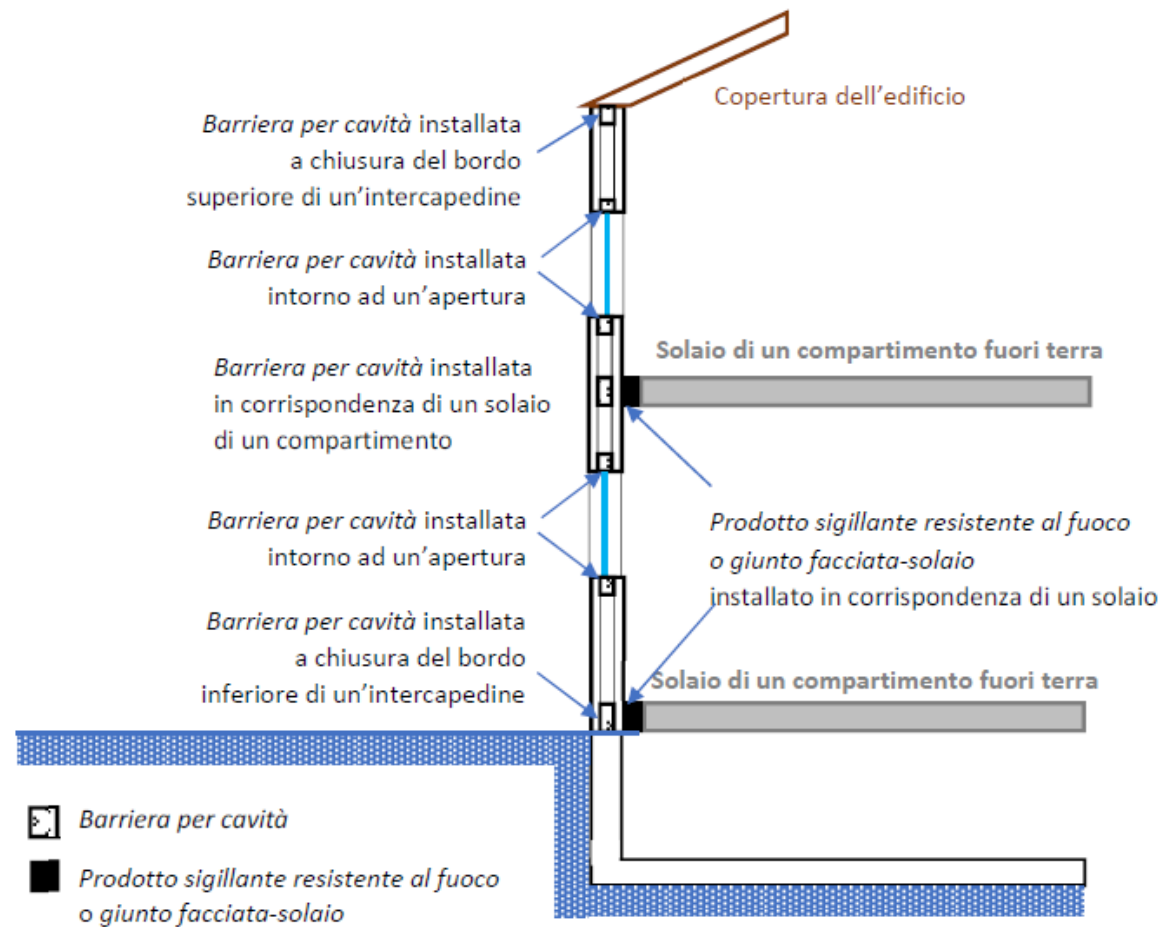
Esempio di parete con intercapedine di ventilazione/cavità estesa a più piani con barriere per cavità
